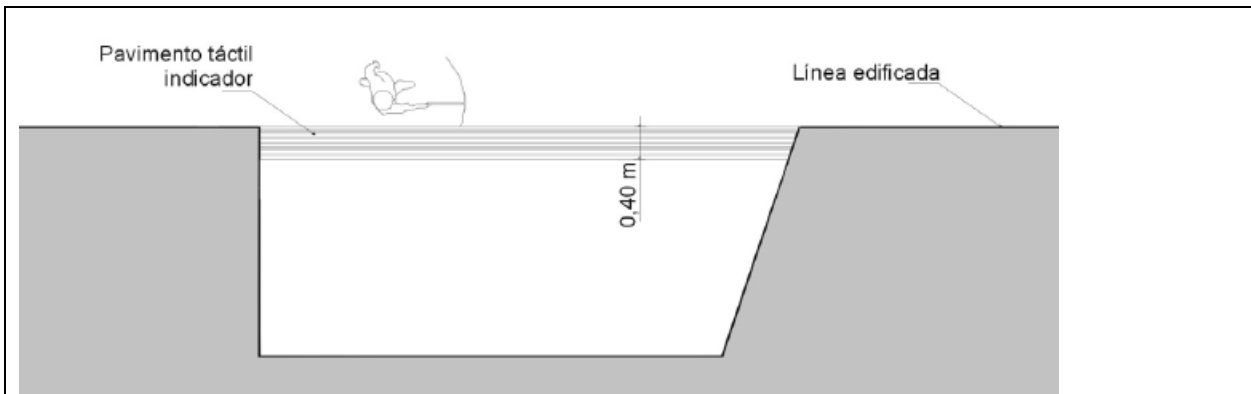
Franja de pavimento táctil indicador direccional que da continuidad a la línea edificada
